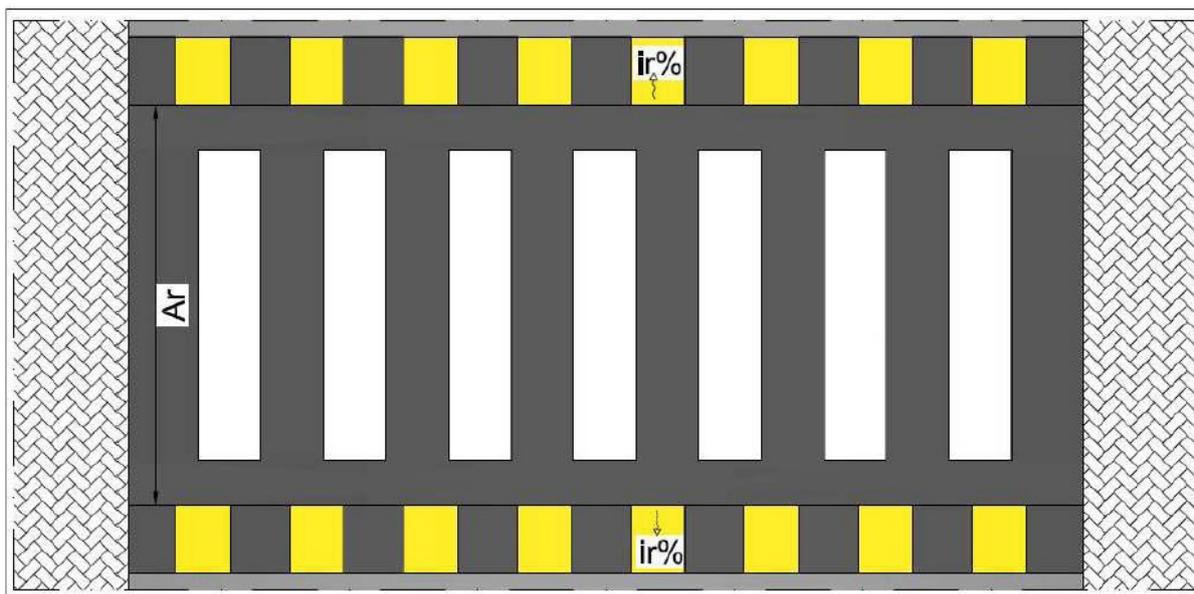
Attraversamento pedonale rialzato Schema (fonte: Linee guida ACI per la progettazione degli attraversamenti pedonali, Norme tecniche)
